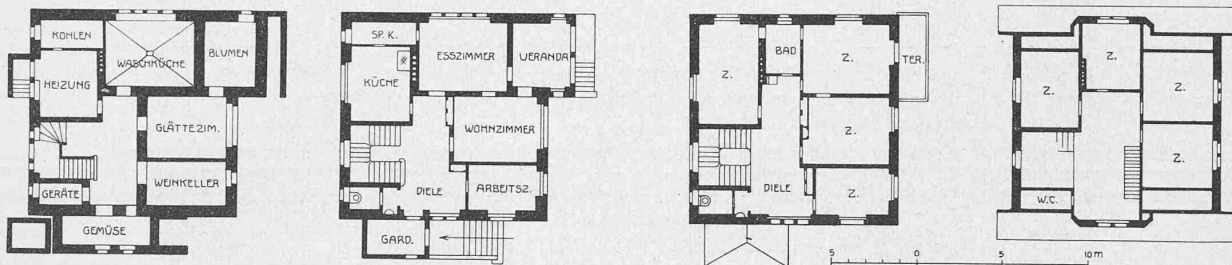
bis 4. Grundrisse vom Keller, Erdgeschoss, Obergeschoss und Dachstock des Hauses J. Zweifel-Kubli in Netstal. — 1:400.
